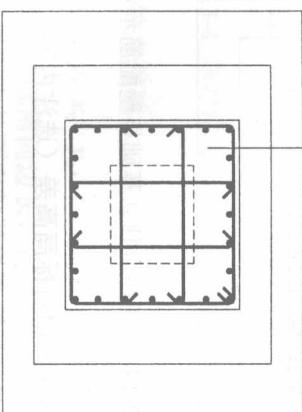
高杯口独立基础杯壁配筋示意
